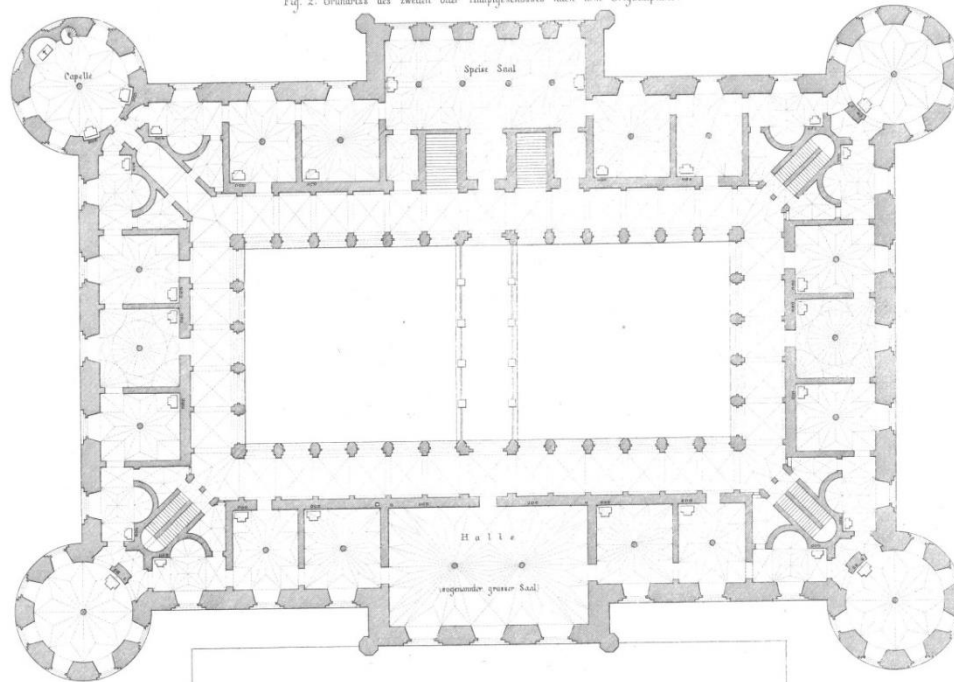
Grundriss des zweiten oder Hauptgeschosses nach dem Originalplane.
